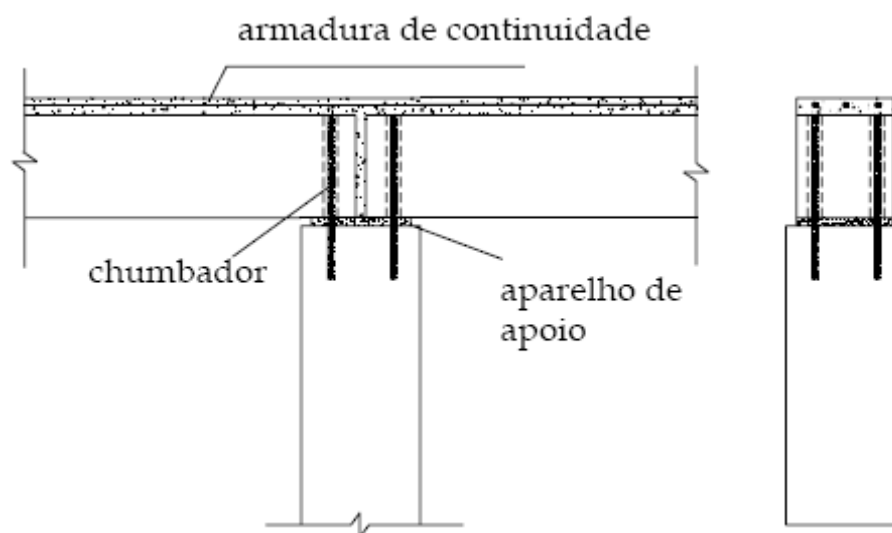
Ligação viga-pilar ensaiada no CERIB (tipo 1) (CHEFDEBIEN, 1998).
